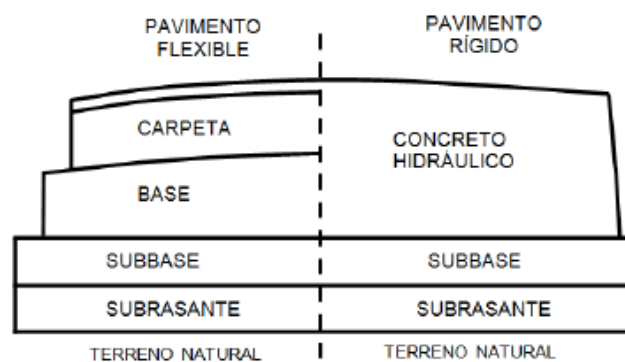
Comparación entre la estructura típica de un pavimento flexible y uno rígido.
